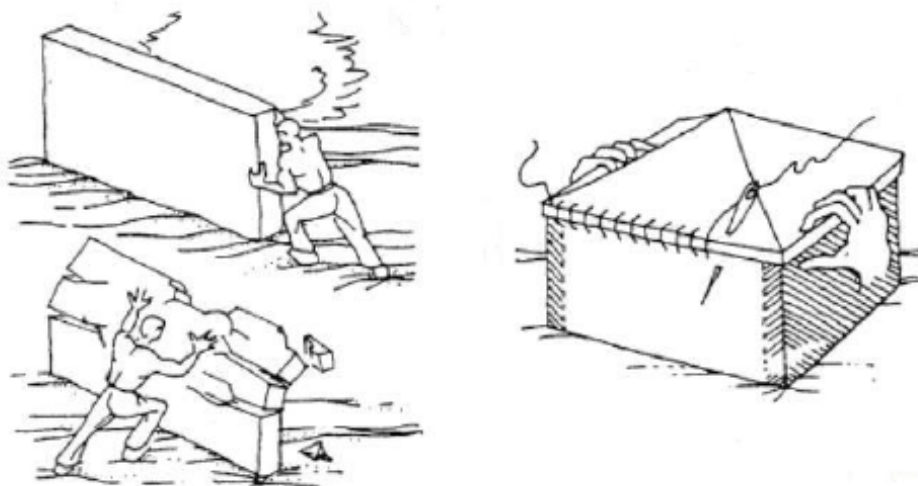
Concezione strutturale di edifici in muratura (Baratto, 2018)
